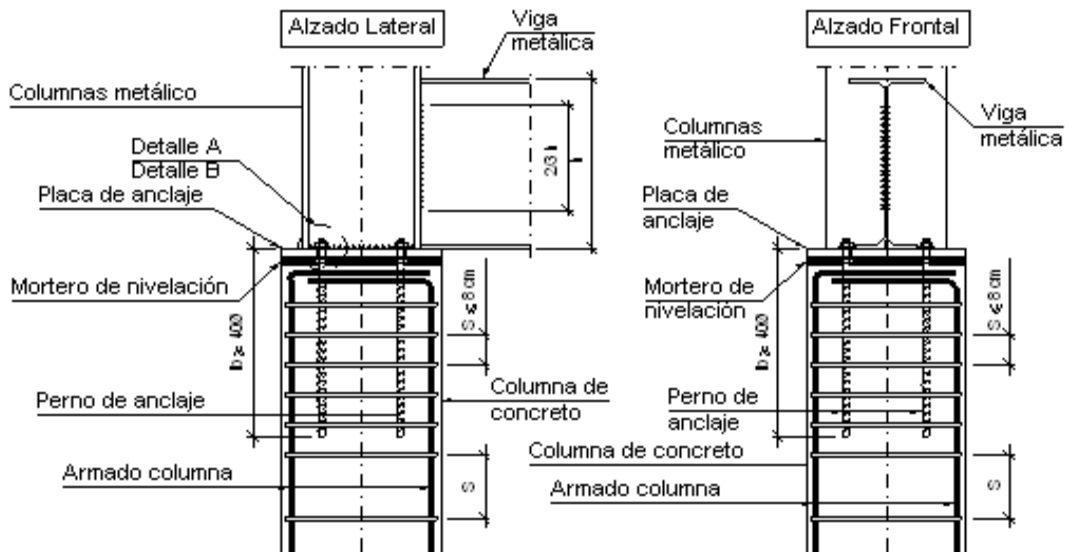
Detalle de Empalme de Columna Metálica con Columna de Concreto. <http://detallesconstructivos.mx.cype.com/EAM020.html>. (2000).
